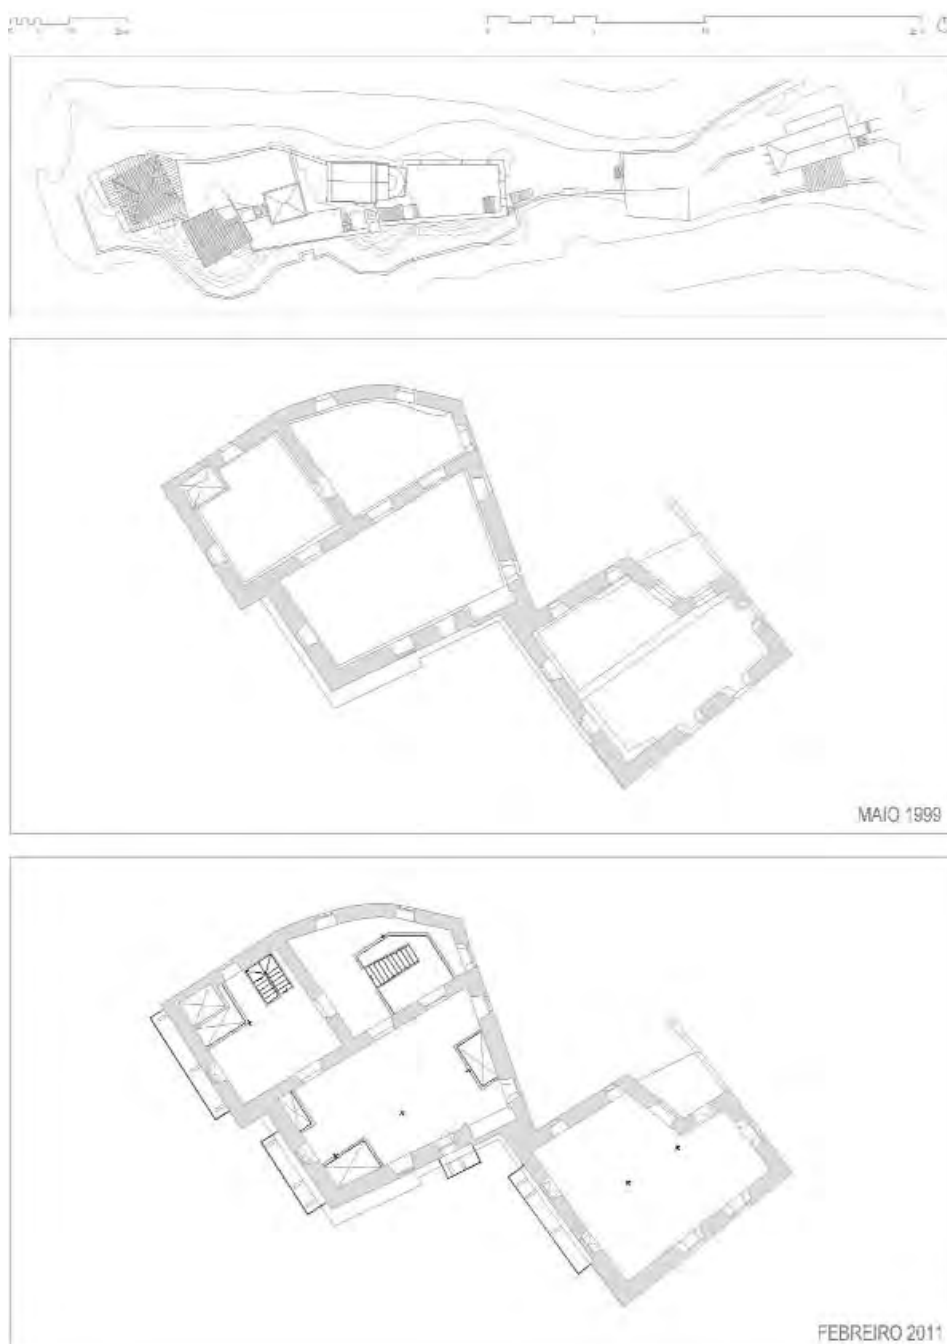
CAAVEIRO. Planta alta da Casa de Quintás (Pavillón de exposicións).
